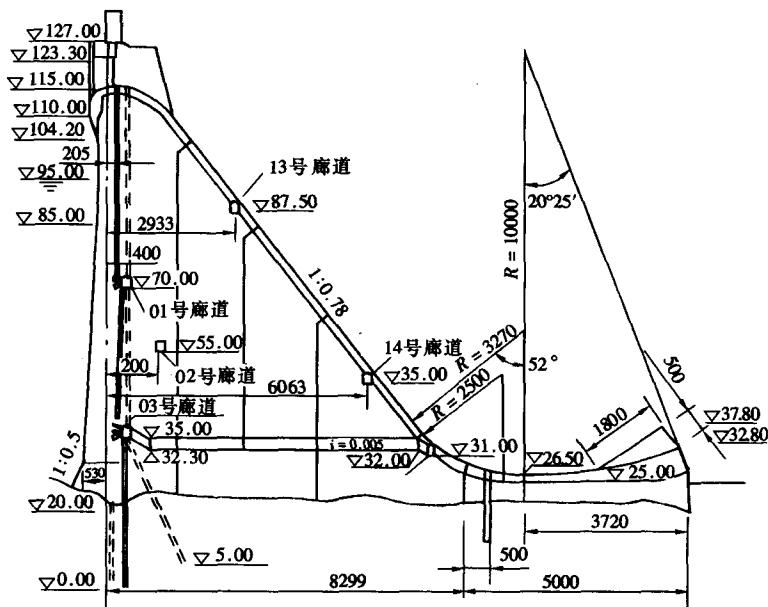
水丰大坝剖面图（尺寸单位：cm，高程单位：m）
